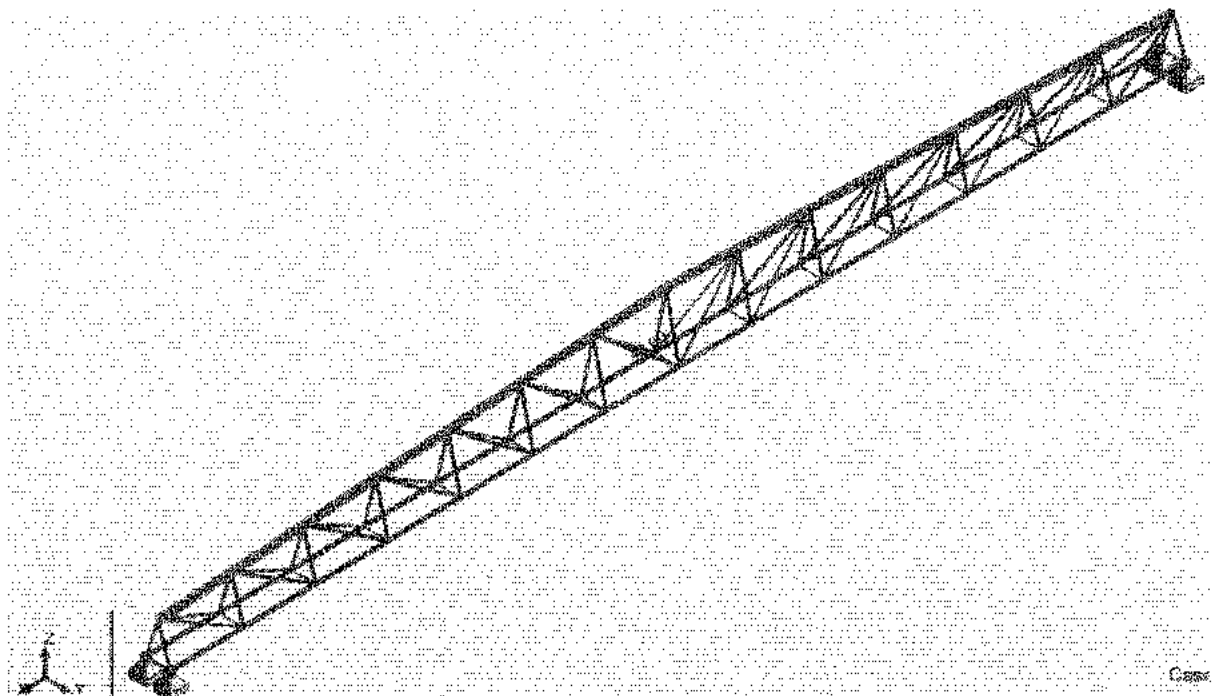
Skive schematica proposta dalla trave reticolare
